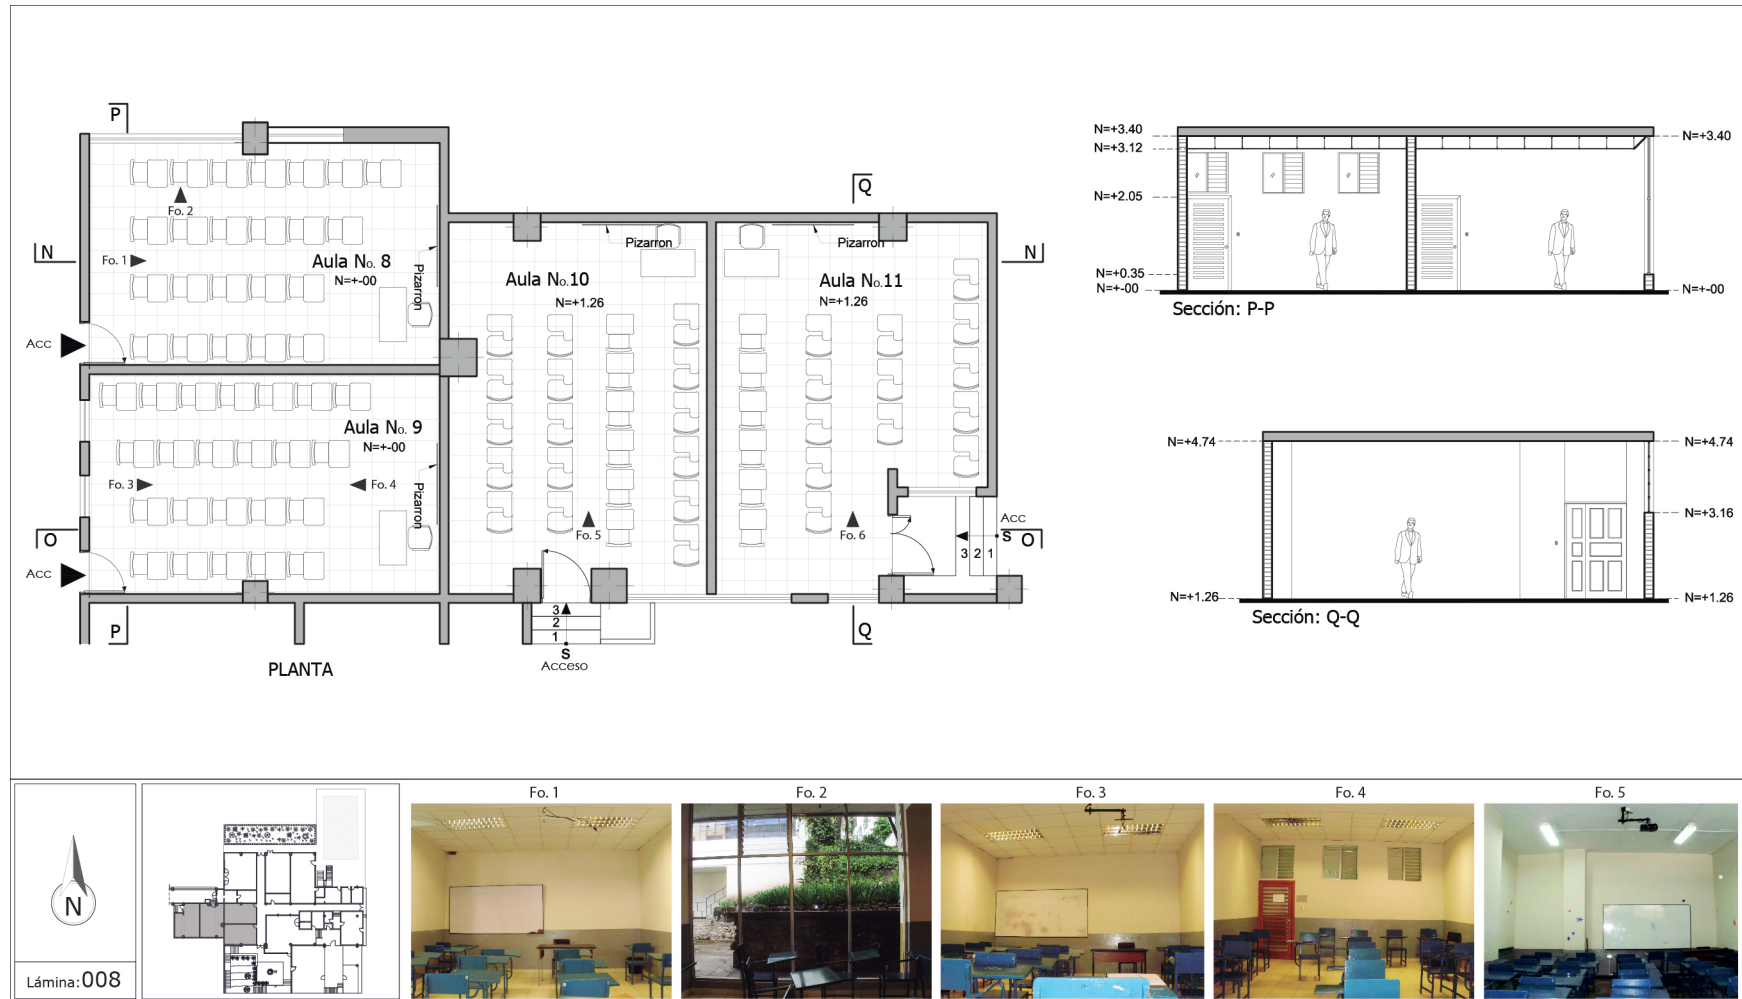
Planta y secciones de las aulas: 8-9-10-11 estado actual.
